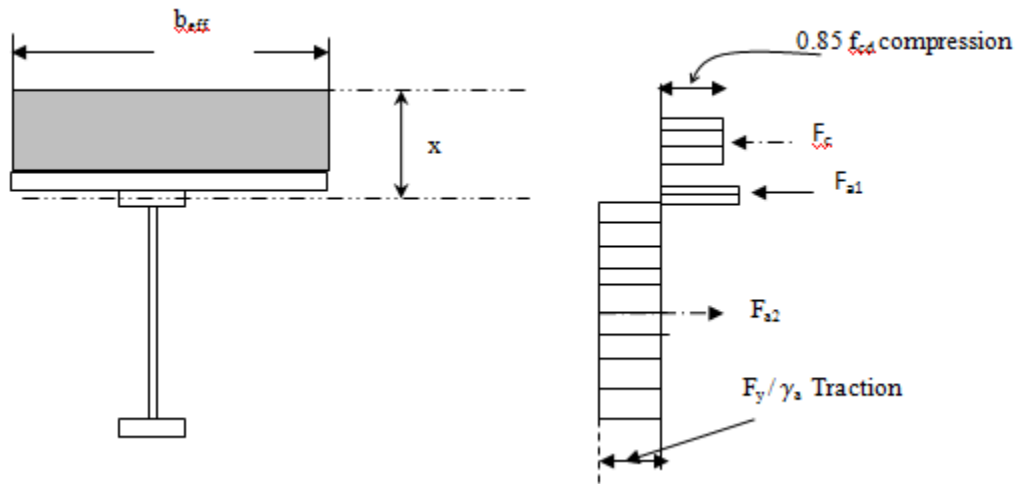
l'axe neutre passe par la semelle supérieure de la poutre en acier.
